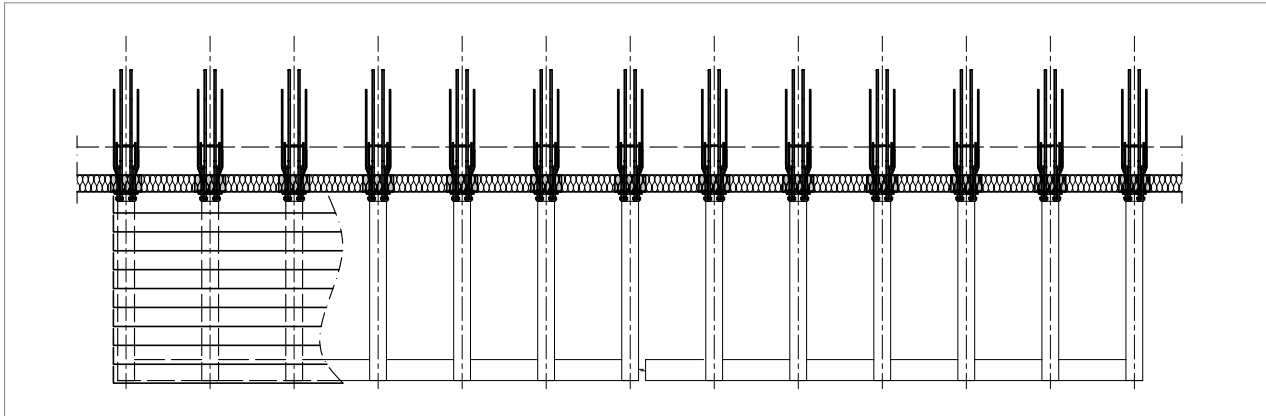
Schöck Isokorb® XT type SK : balcon en porte-à-faux
